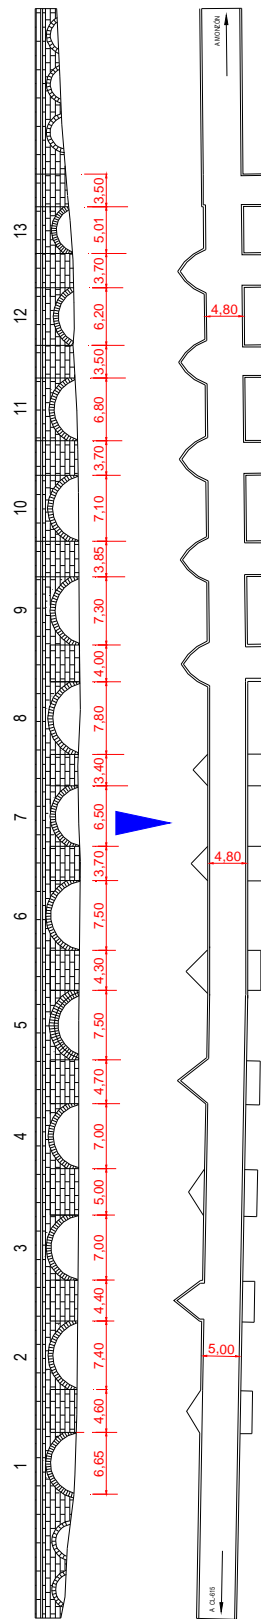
Dibujo de planta y alzado del puente en Monzón de Campos.
